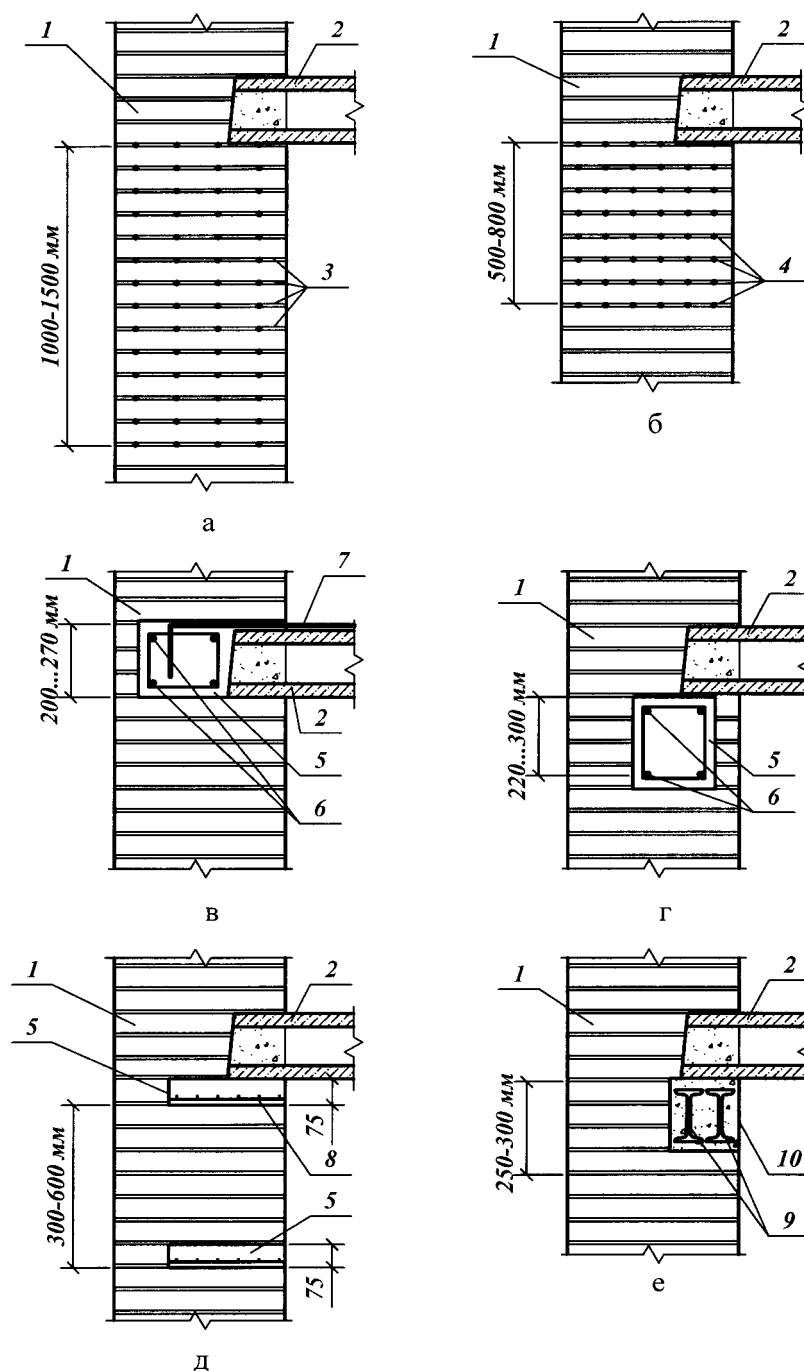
Увеличение жесткости кирпичных стен при надстройке этажей:
